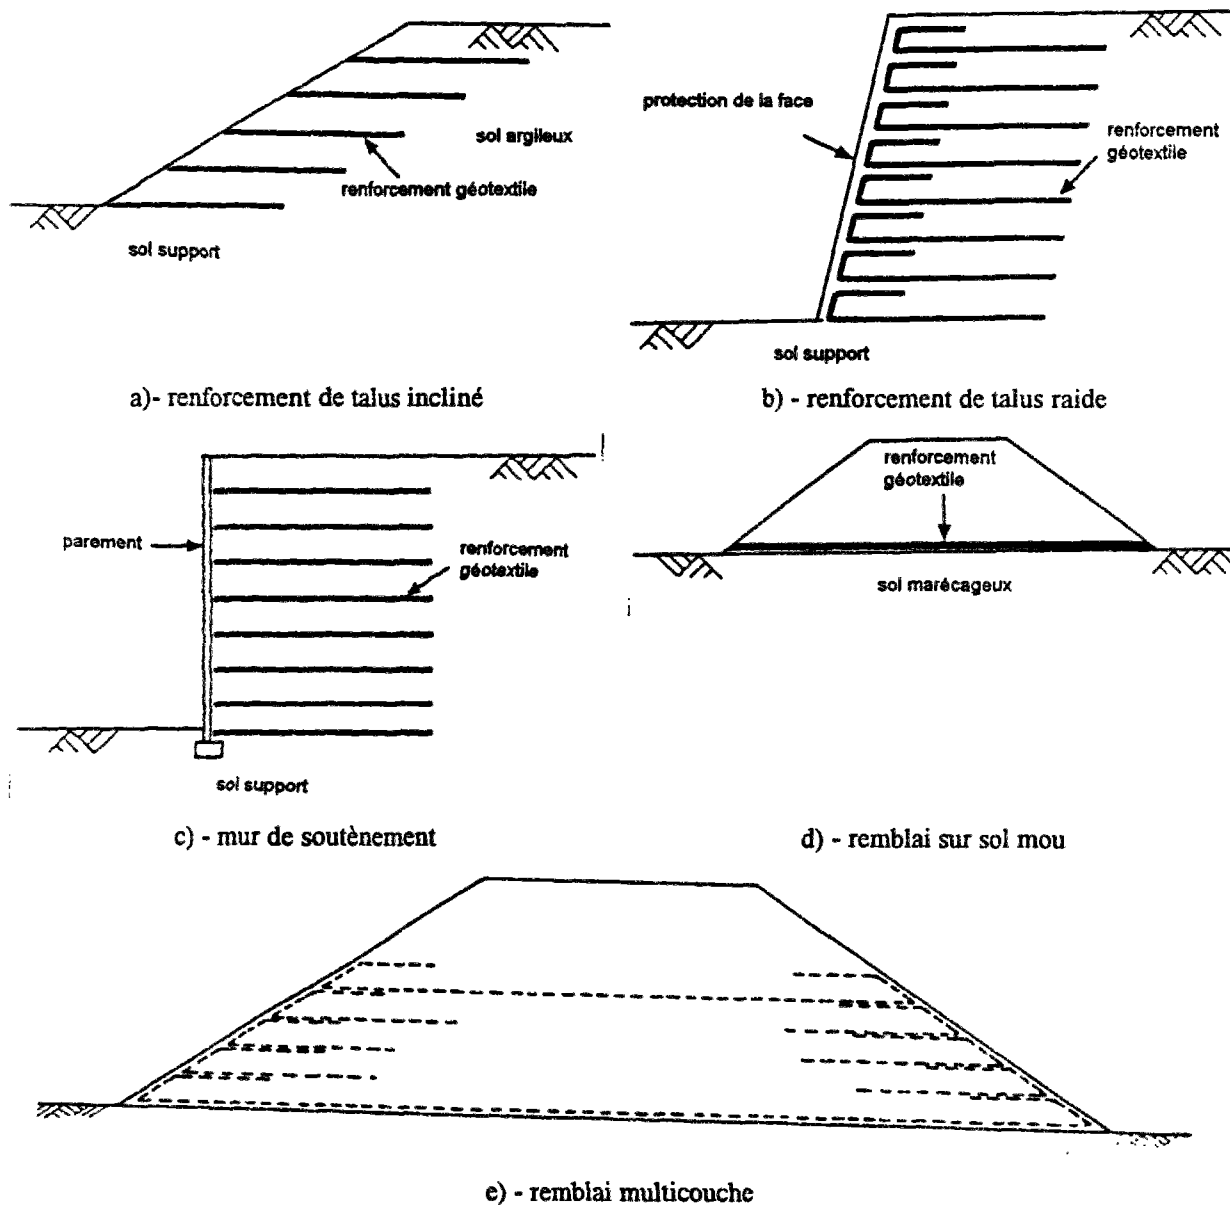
Exemples d'application de géotextiles pour le renforcement
